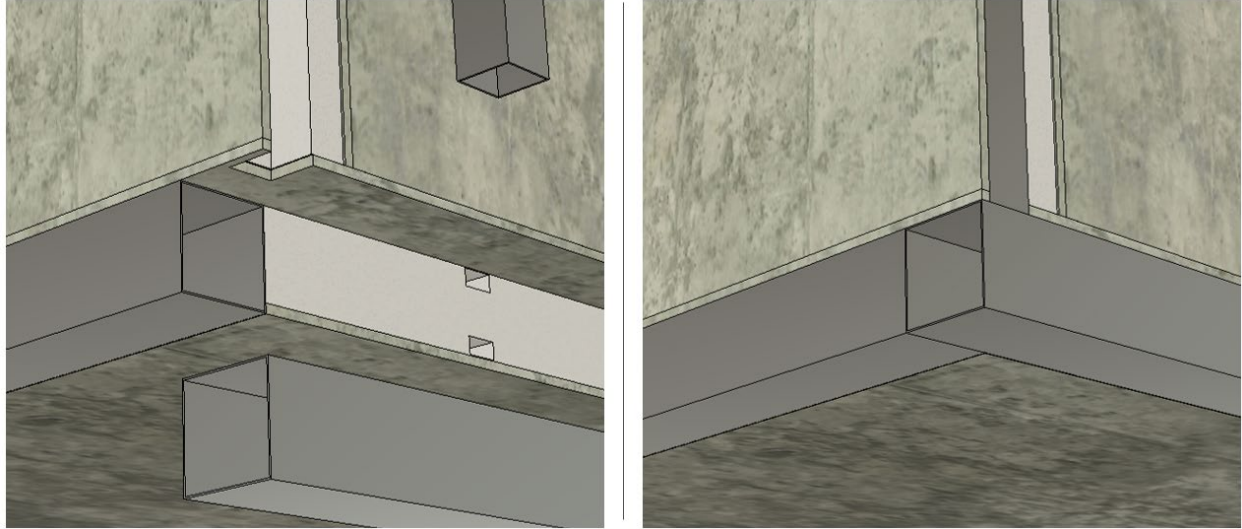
Detalle de colocación de refuerzo estructura para mueble habitable. Elaboración propia.
